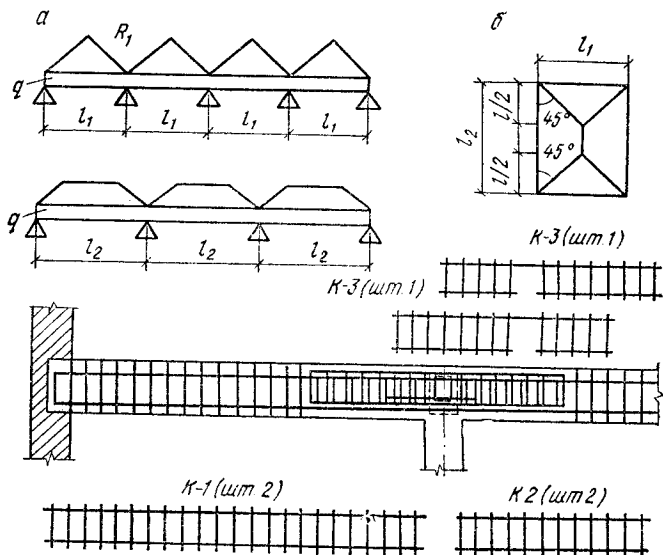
Расчетные схемы и армирование балок ребристых перекрытий с плитами, опертыми по контуру
